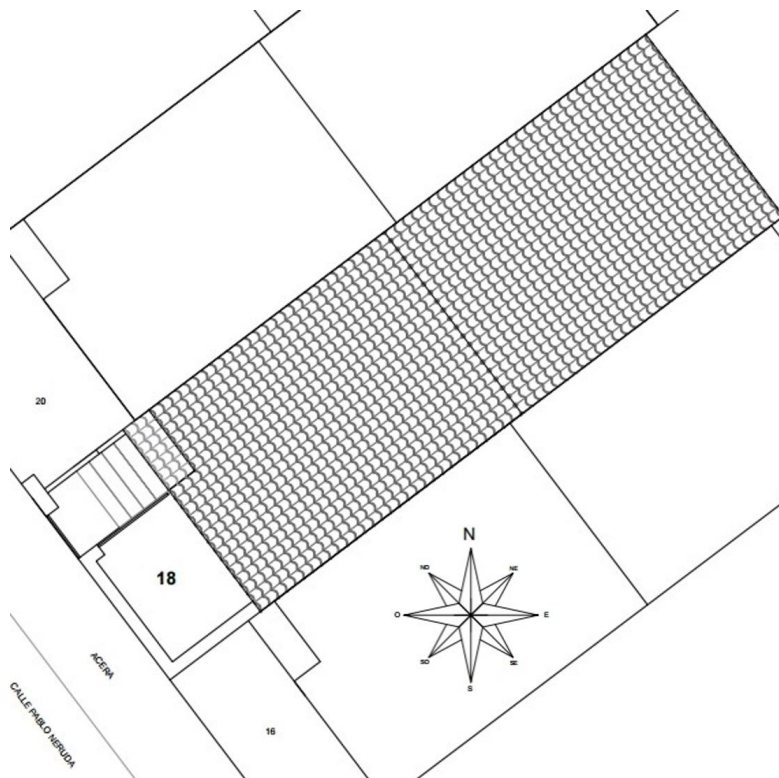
Detalle en planta del tejado de la vivienda y la orientación (Fuente: Elaboración Propia)
